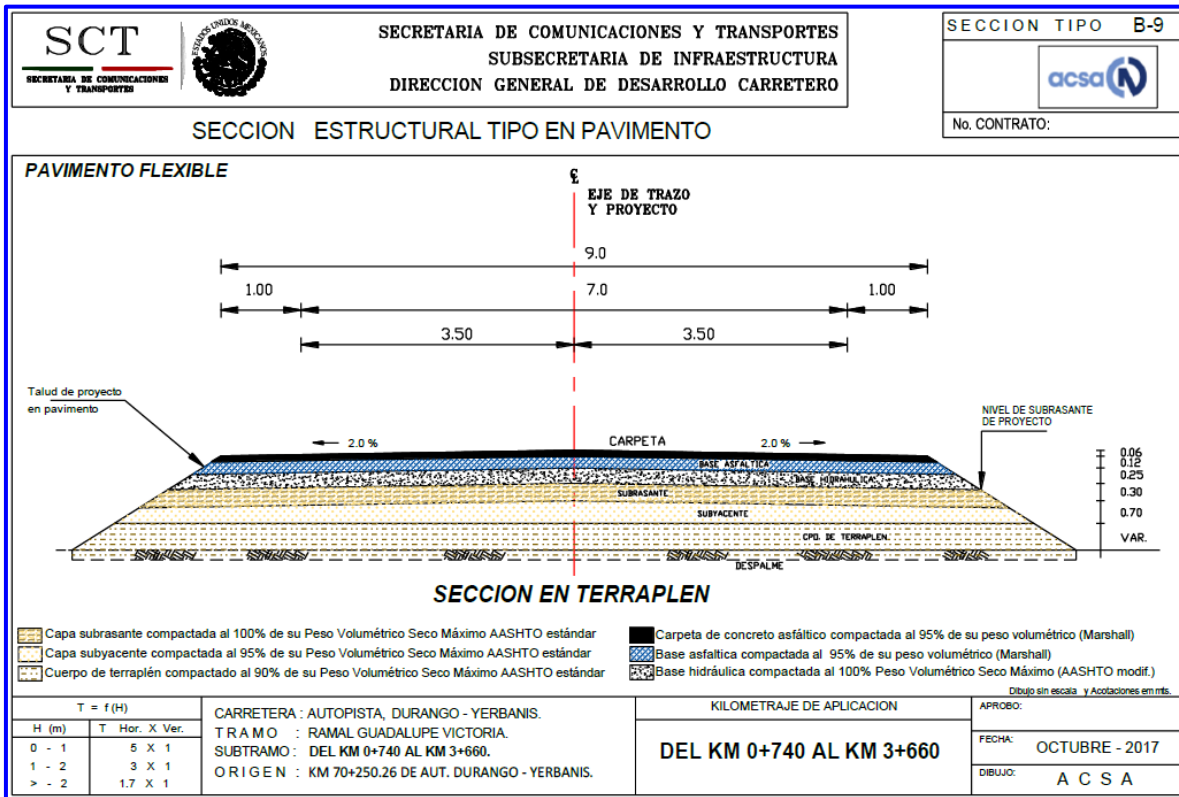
SECCIÓN ESTRUCTURAL TIPO (EN TERRACERÍAS)
